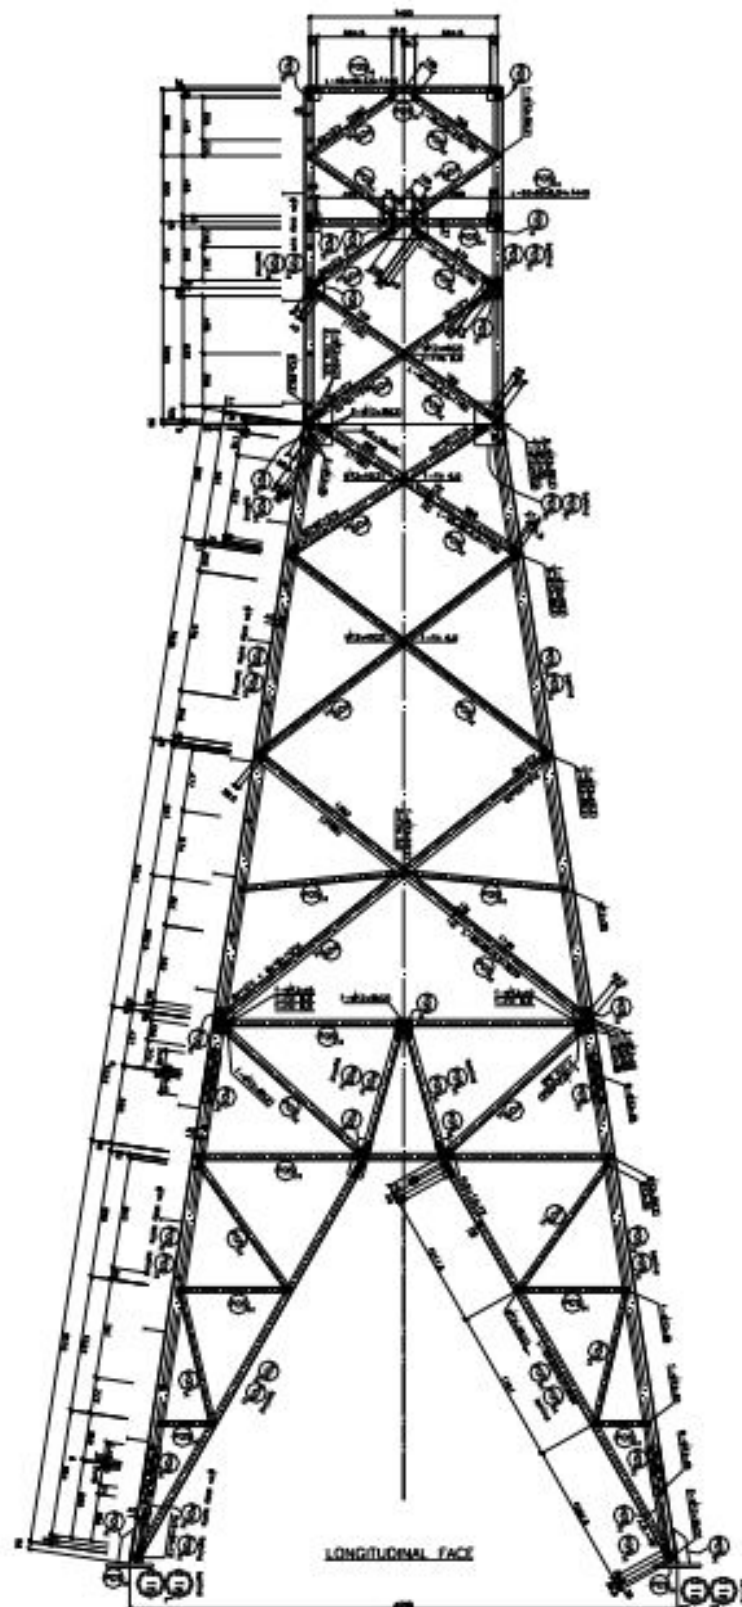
Estrutura "2A"- detalhamento da face longitudinal.
